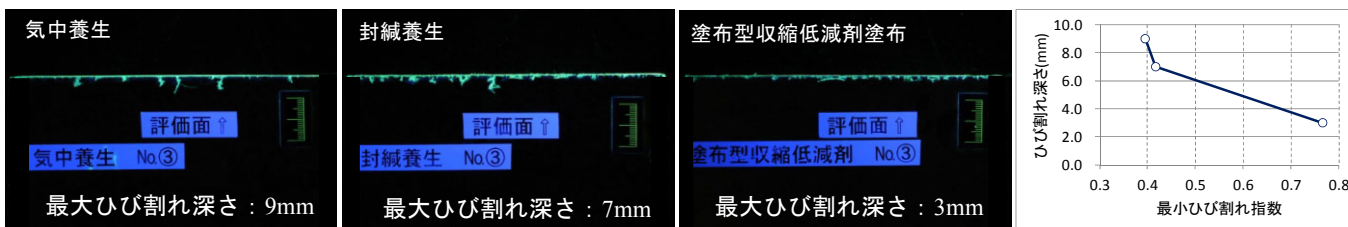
蛍光エポキシ樹脂含浸によるひび割れ観察写真
